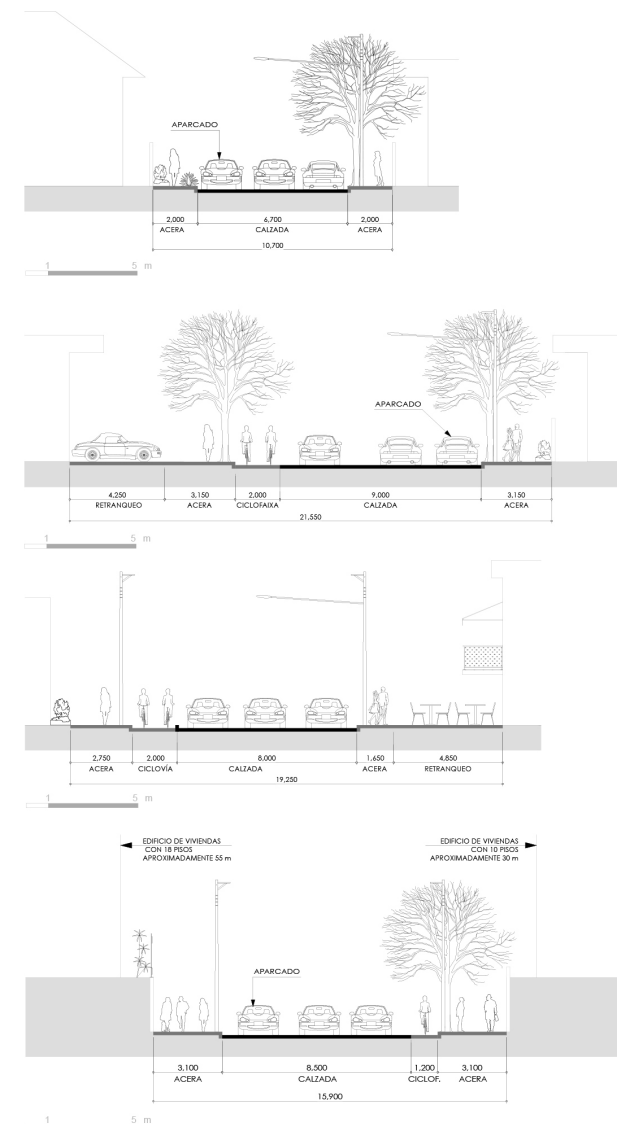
Secciones esquemáticas de las calles Ubatuba y Piauí a lo largo del recorrido. Fuente: Elaboración propia
